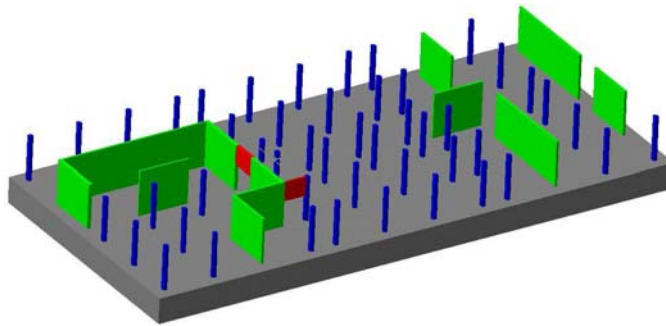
Alternativas de posições para pilares e paredes. Fonte: PULMMANN *et al.* (2003).
